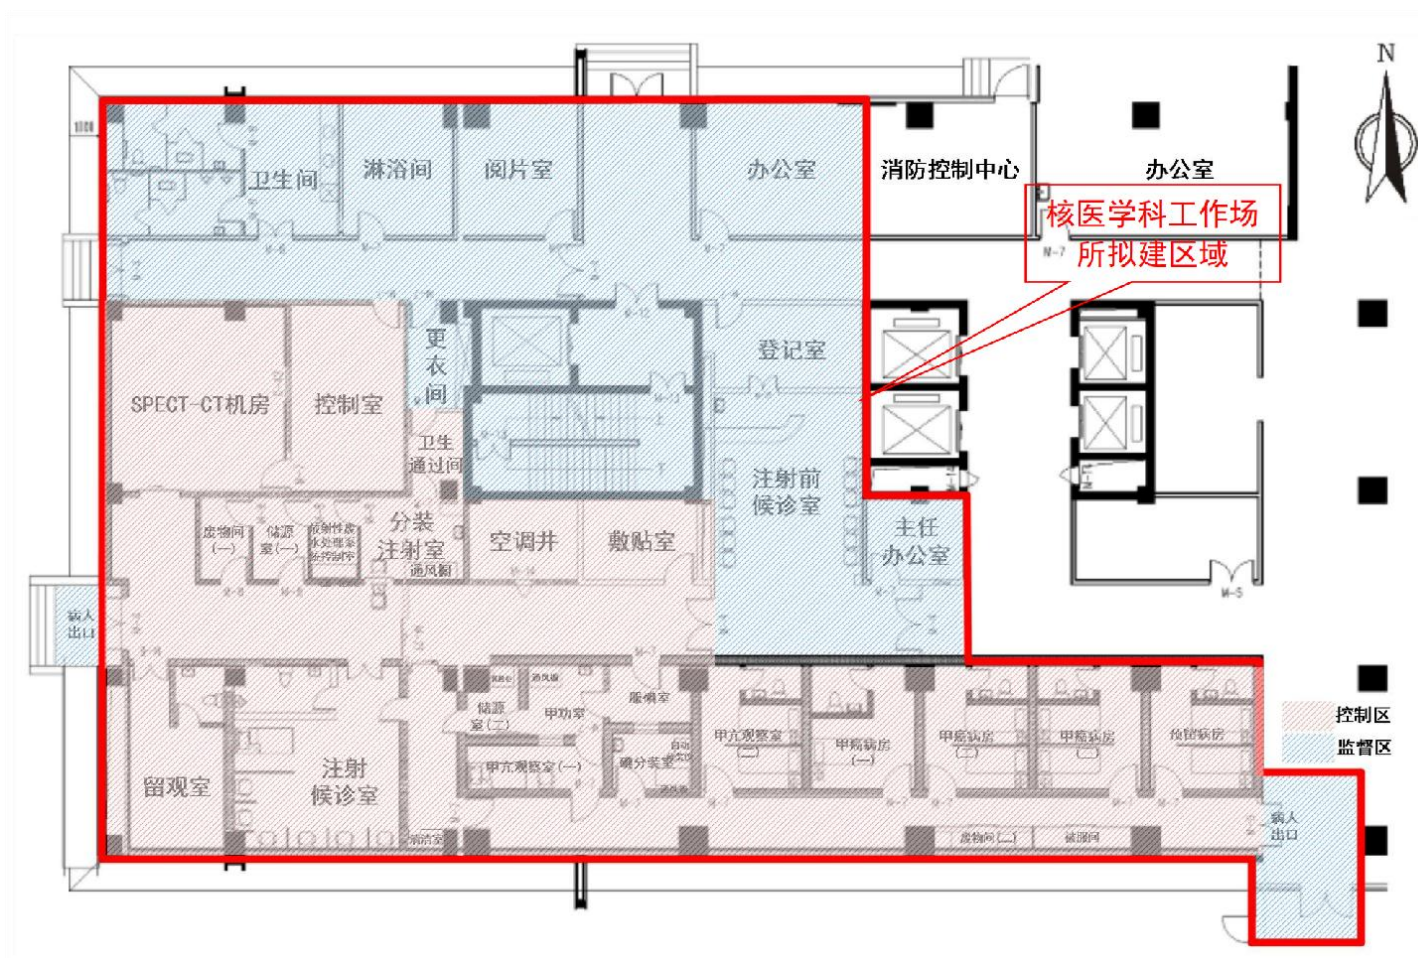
(a) 工作场所平面布置示意图 (变动前)
